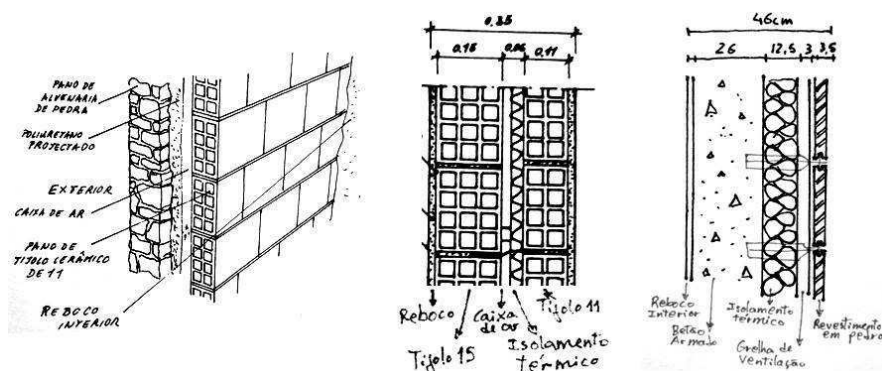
Constituição de uma parede exterior mista em pedra e tijolo, de uma parede exterior tradicional (dois panos de tijolo) e uma parede exterior em betão ventilada (sistema Etics). (Ilustração nossa, 2014)
